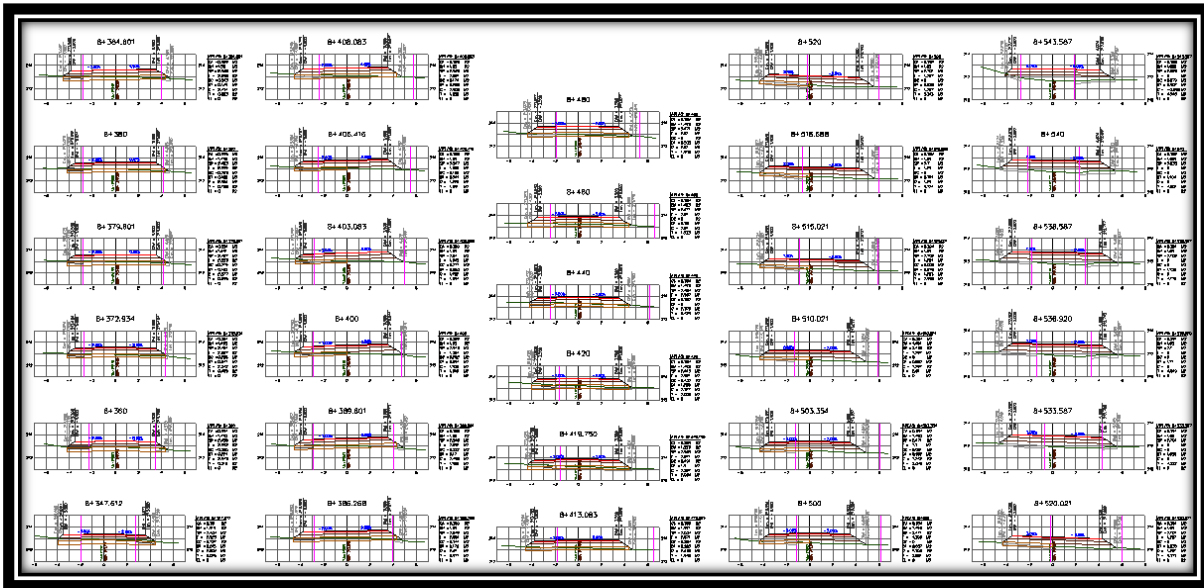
Secciones de construcción del km 8+347.612 al km 8+543.587.
